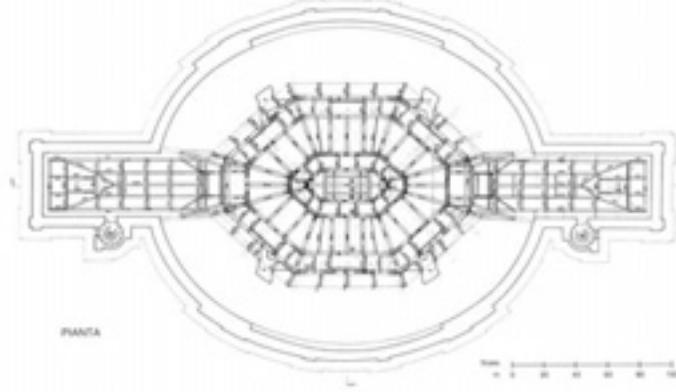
Stupinigi. Fondazione Palazzina Mauriziana di Stupinigi. Salone centrale e appartamenti Reali. Pianta
